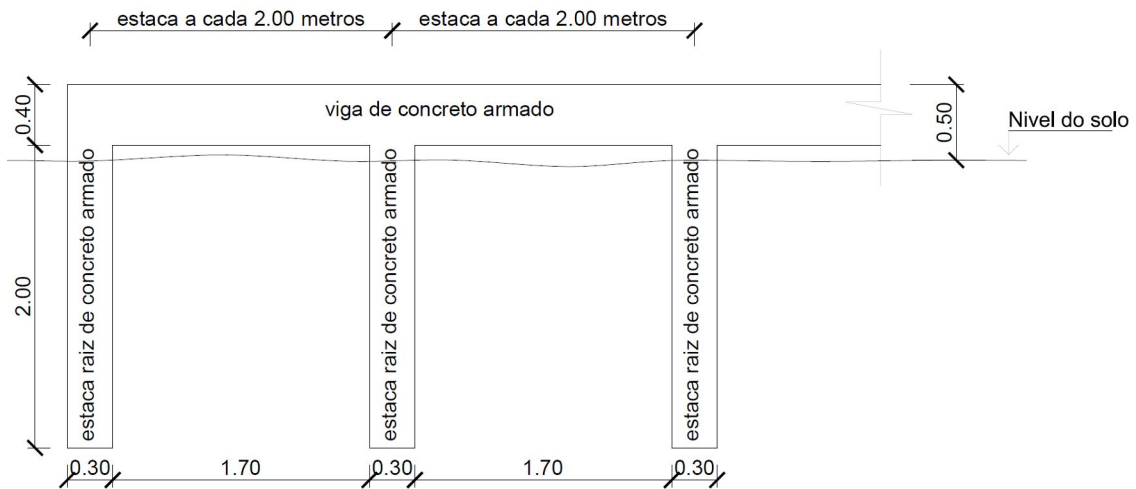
Detalhamento do bloco de assentamento das escolas em corte.
